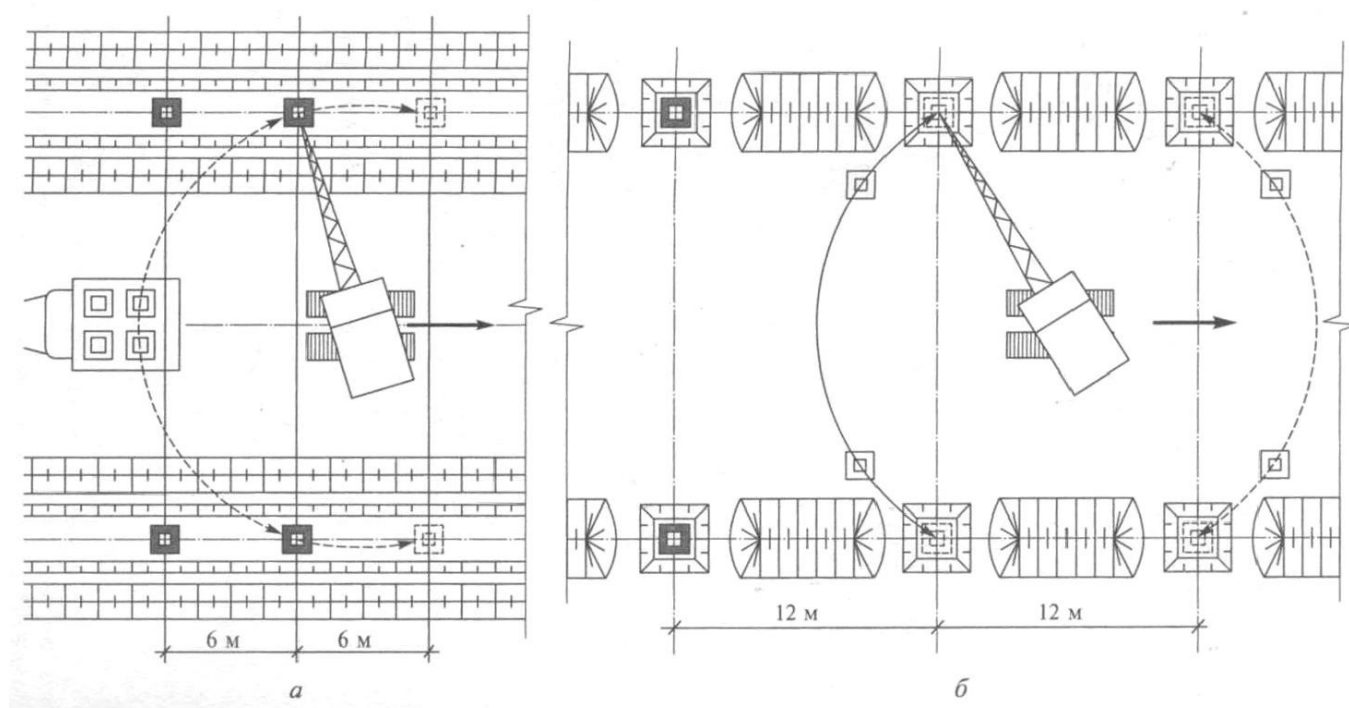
Монтаж столбчатых фундаментов. а-с транспортных средств; б-с предварительной раскладкой
